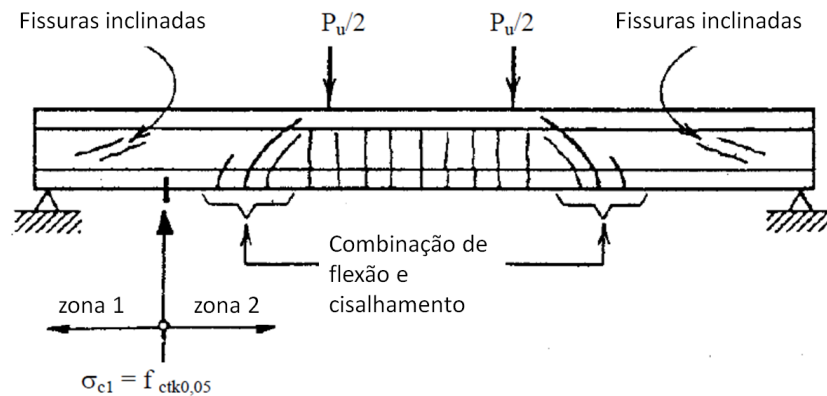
Padrões e regiões de fissuras em elemento de concreto armado ou protendido (traduzido de FIB (2011))
